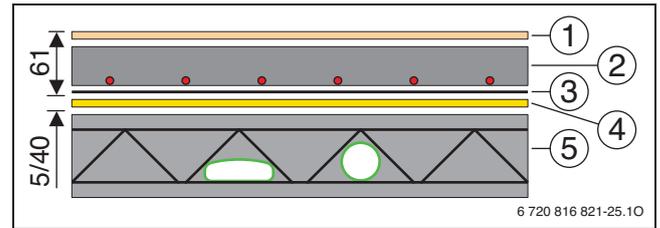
Canale tondo/piatto nel soffitto in cemento grezzo (misure in mm)
